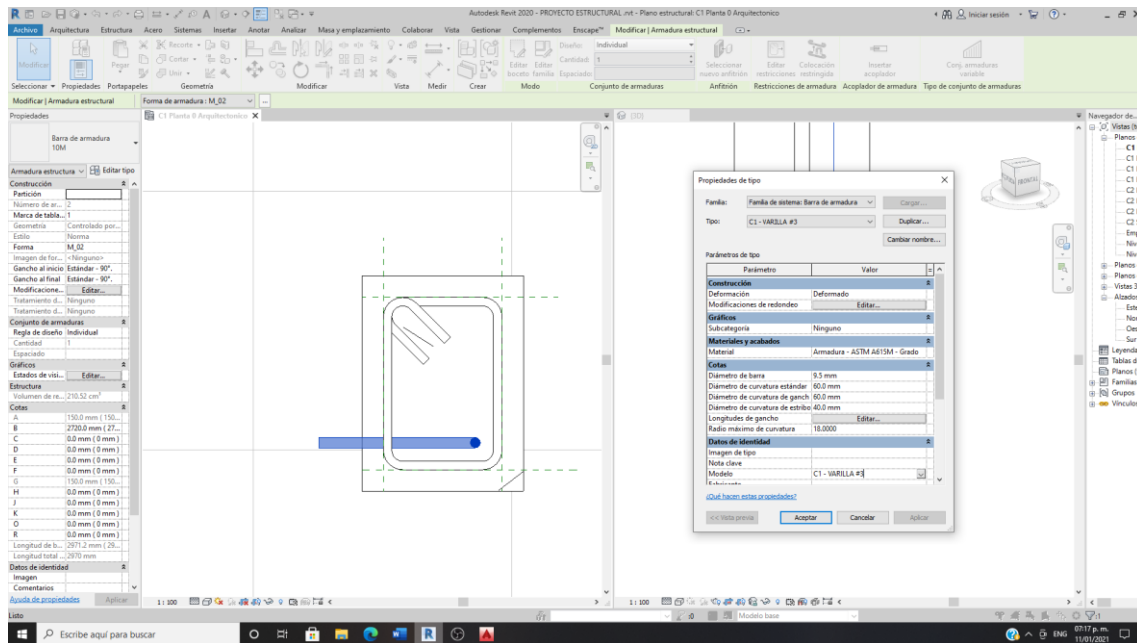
Configuración de armazones estructurales. Fuente: (Elaboración propia Cajica, J. 2020)
